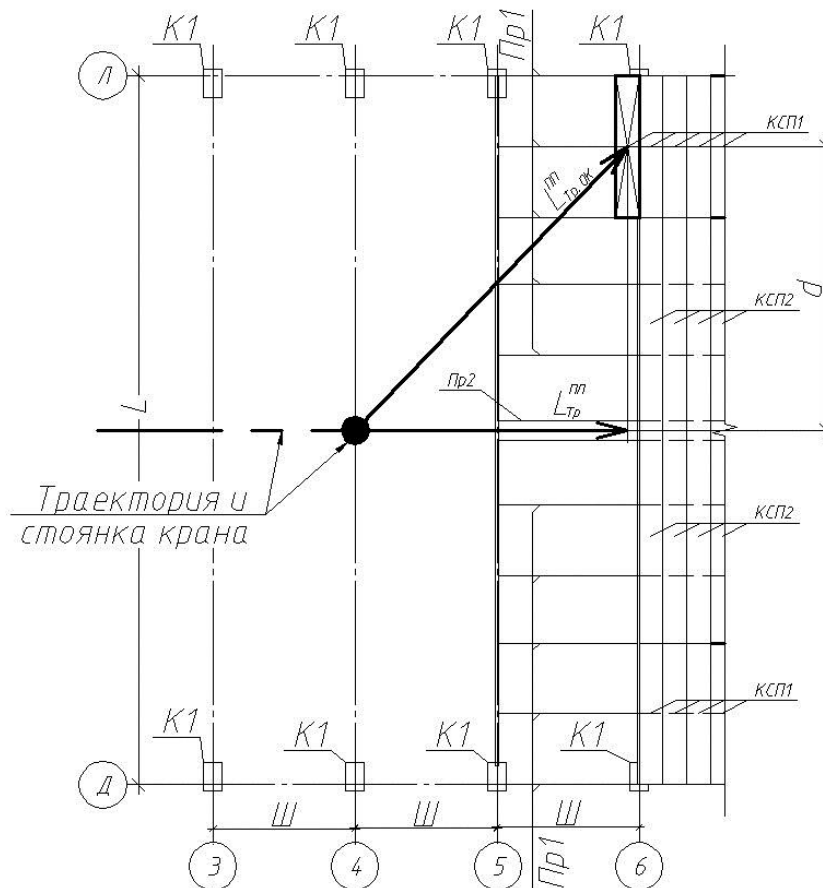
Расчетная схема к определению $L_{тр}$ при монтаже краном панелей покрытия ячейки здания с одной стоянки крана
